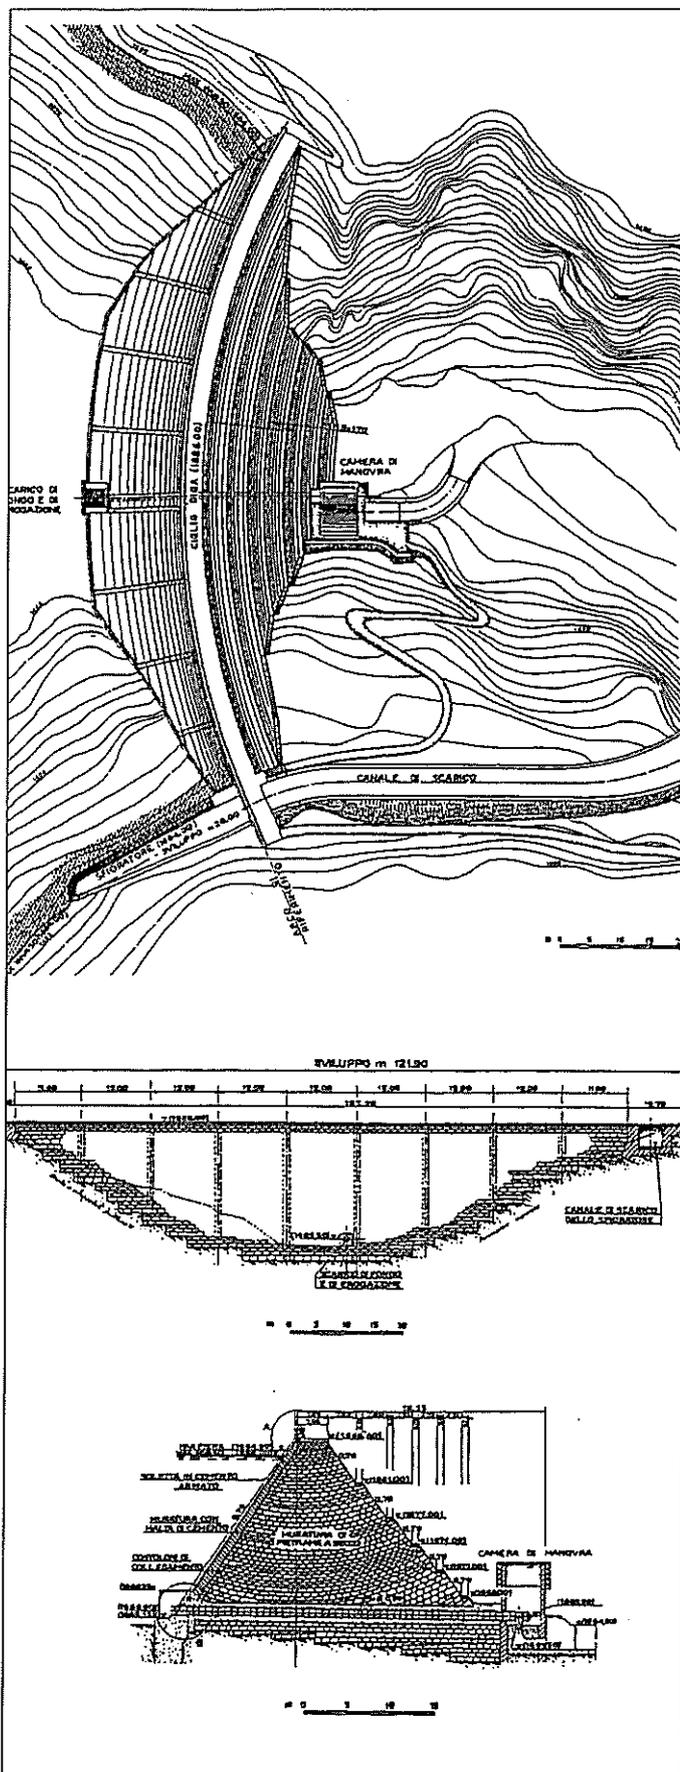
Diga Lago Vargno: Planimetria - Vista da monte - Sezione tipo.
